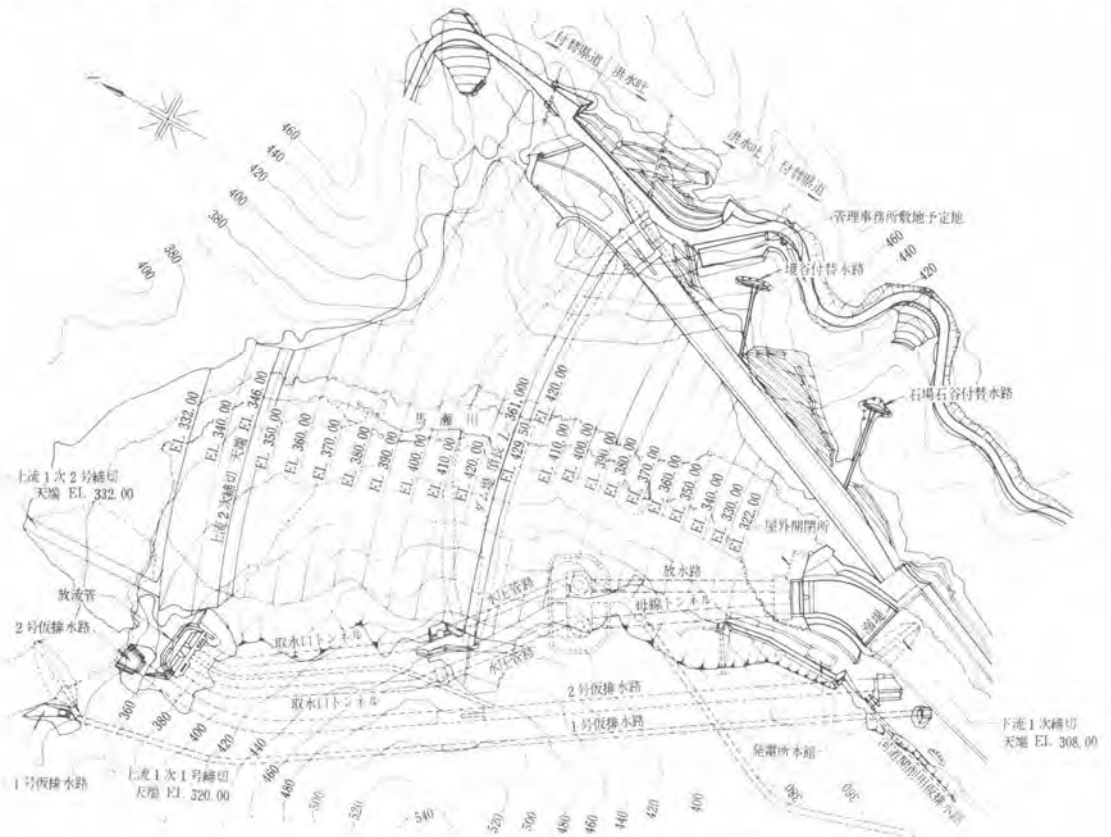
岩屋ダム馬瀬川第1発電所付近一般平面図
